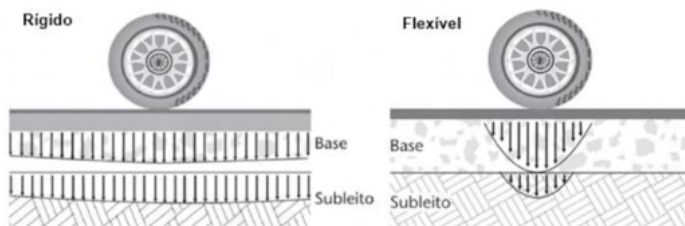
Deformações nos pavimentos do tipo flexível e rígido.
